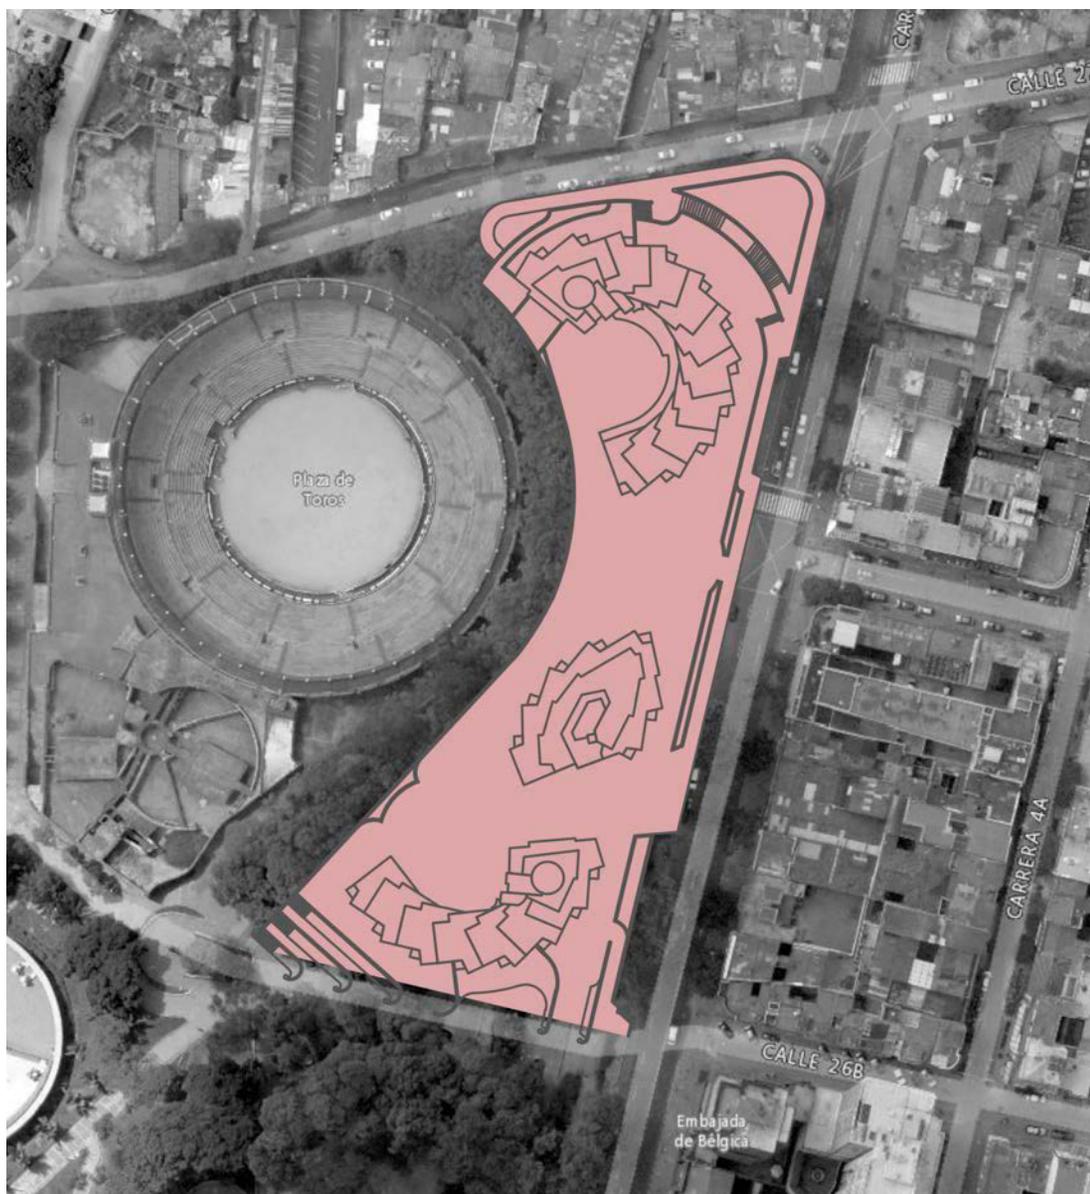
Imagen satelital y montaje del proyecto, Conjunto Residencial Torres del Parque
